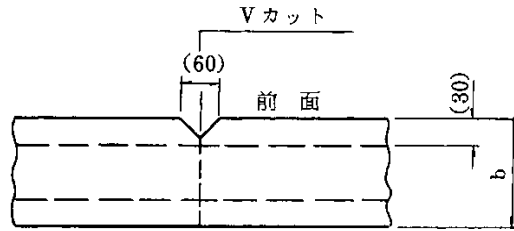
III-36 収縮目地の構造(鉄筋コンクリート擁壁)
